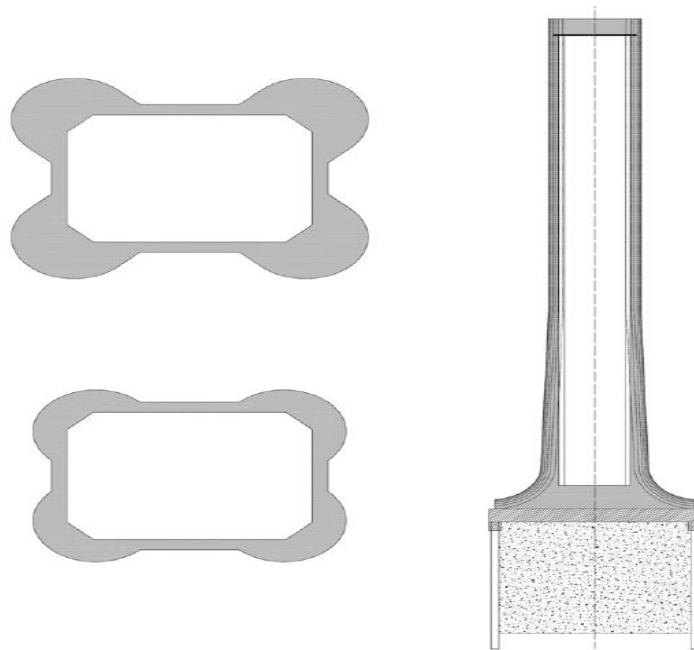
Piles à section constante sur fondations profondes en puits (P2 / P3 / P4 / P5 / P13 / P15)
